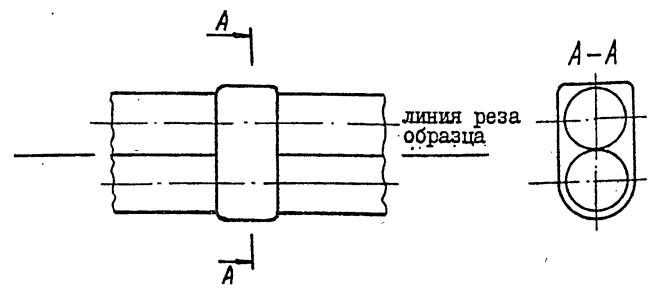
Схема резки сварного соединения спаренных стержней арматуры на два "образца-свидетеля"
